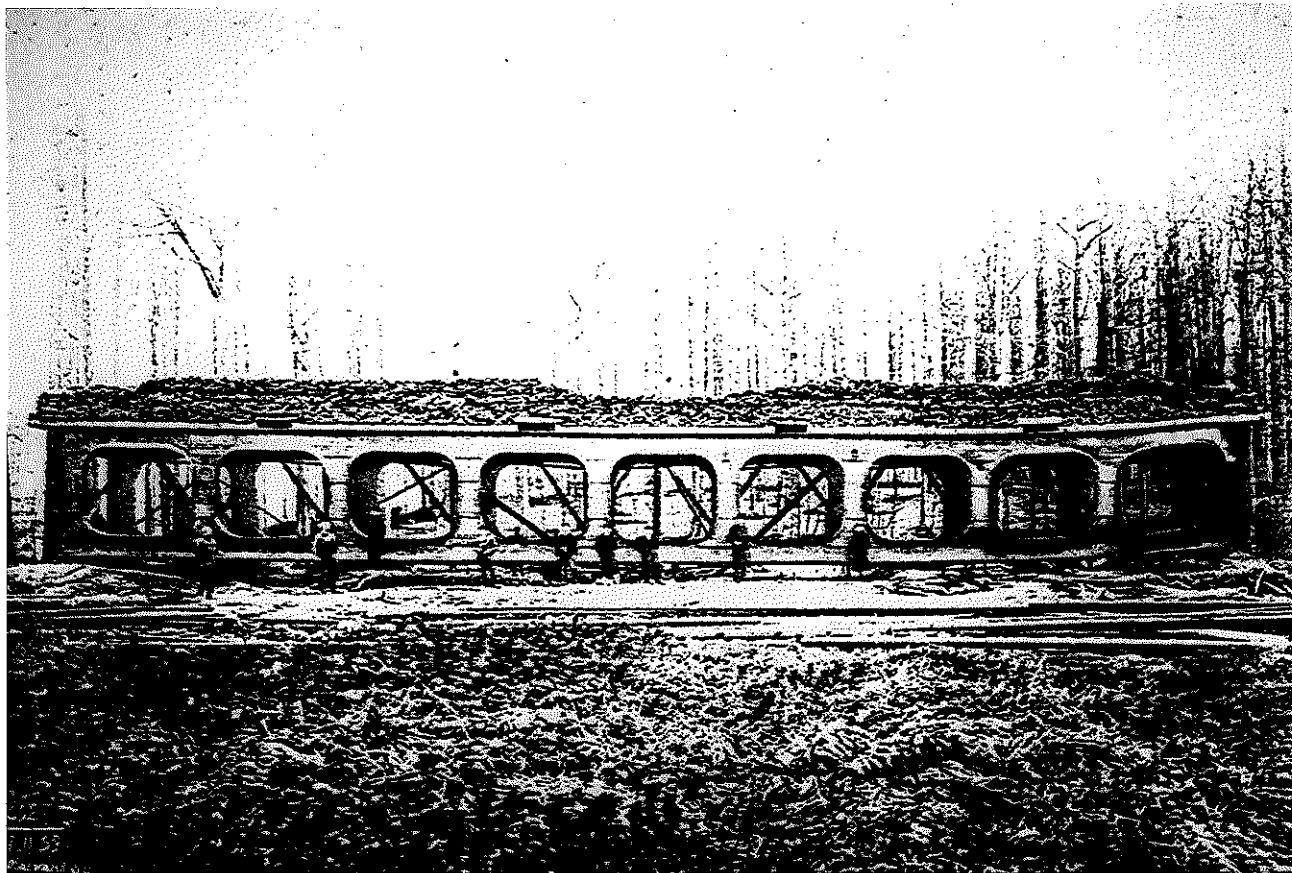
Vista da Viga Ensaçada por Vierendeel
